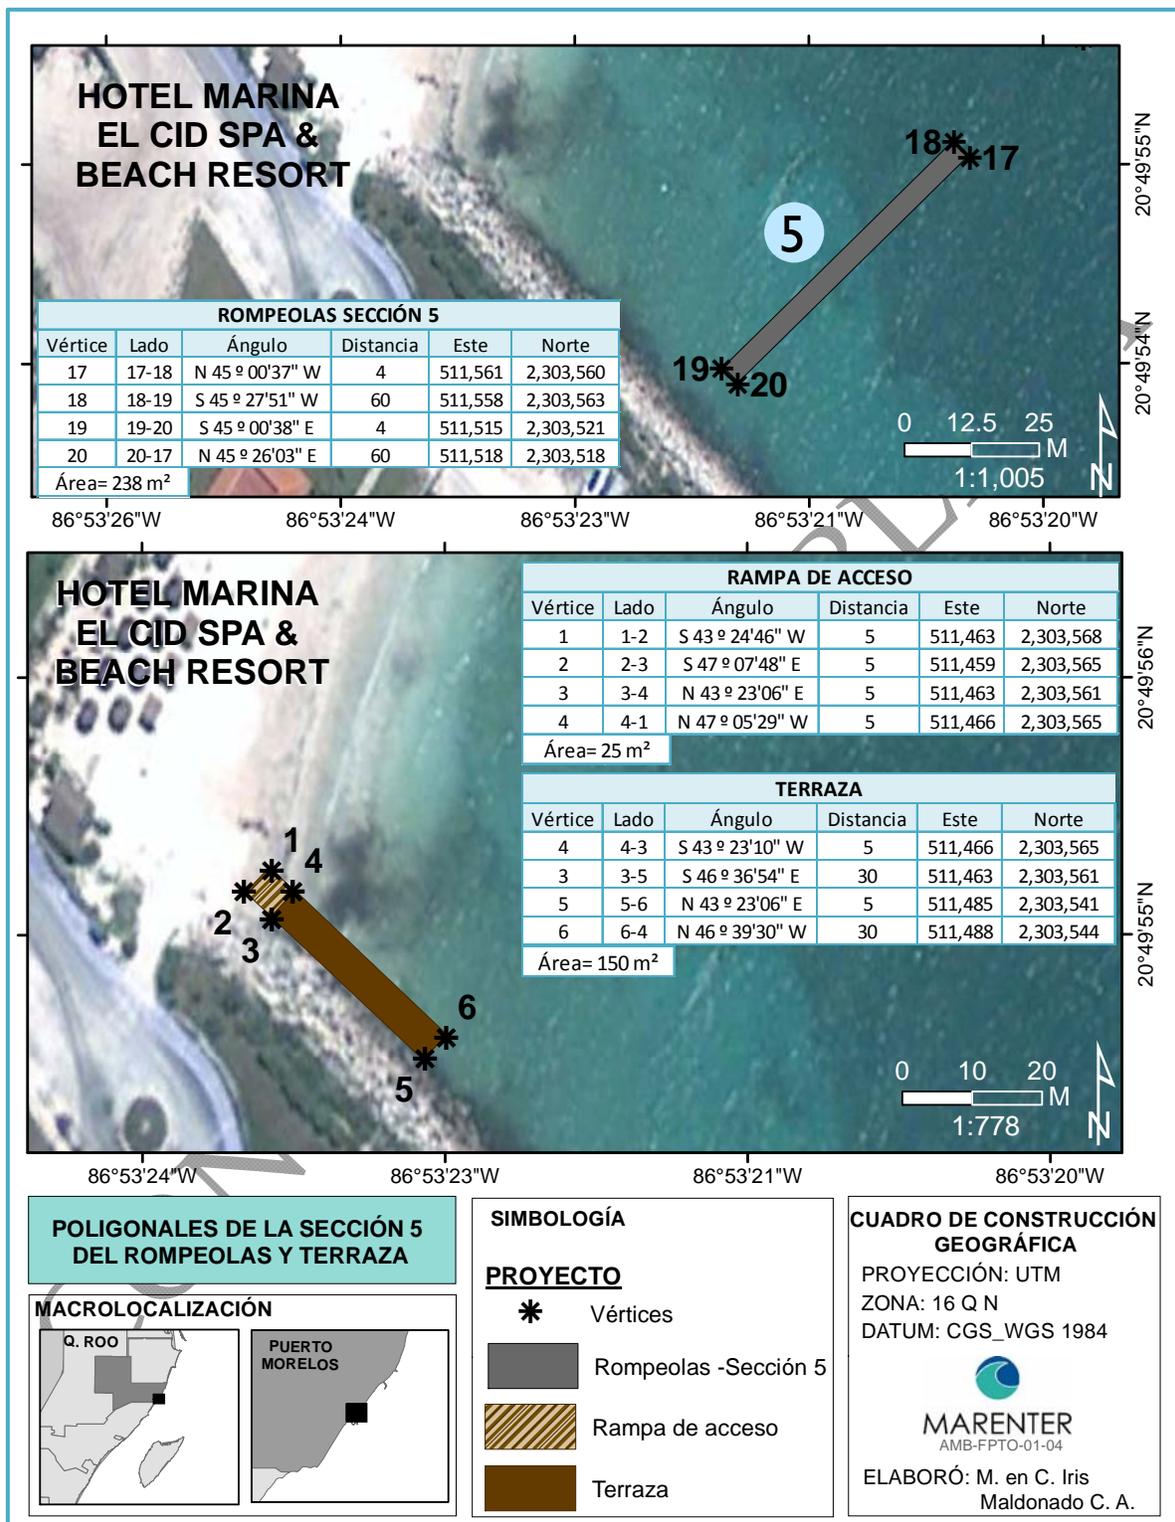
Mapa con el cuadro de construcción en coordenadas UTM de la sección de rompeolas 5, terraza y rampa de acceso.
